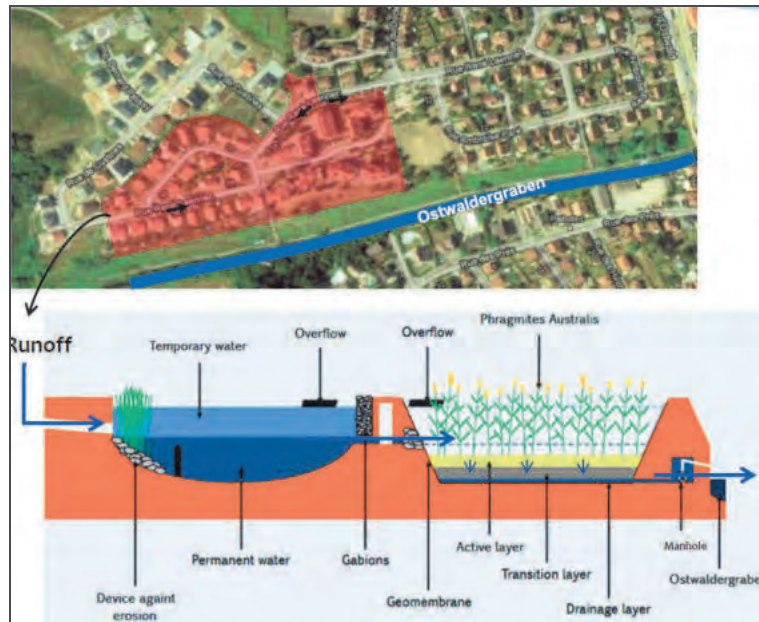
Plan de masse et schéma de la filière de traitement des eaux pluviales
